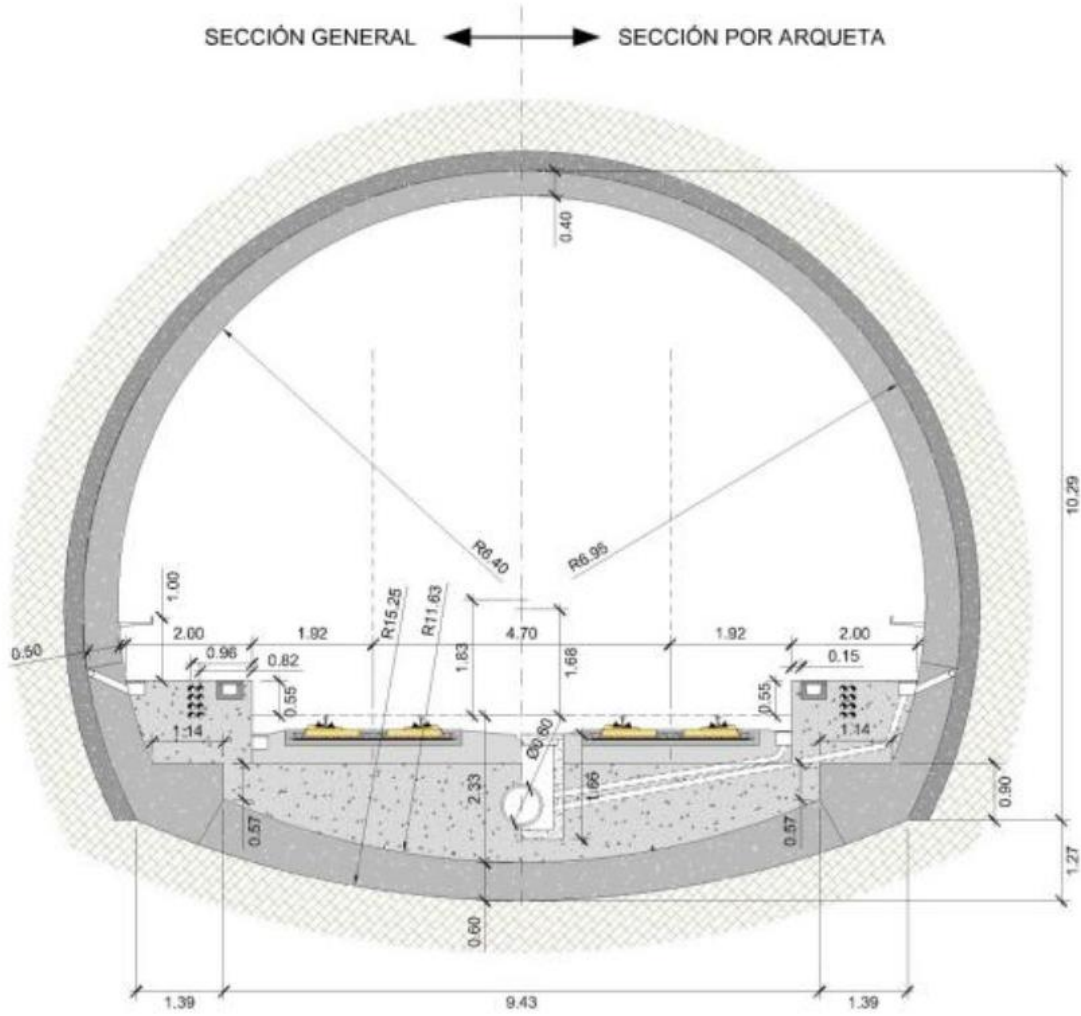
Sección tipo túnel de Pancorbo. Fuente: Proyecto constructivo 2013.
